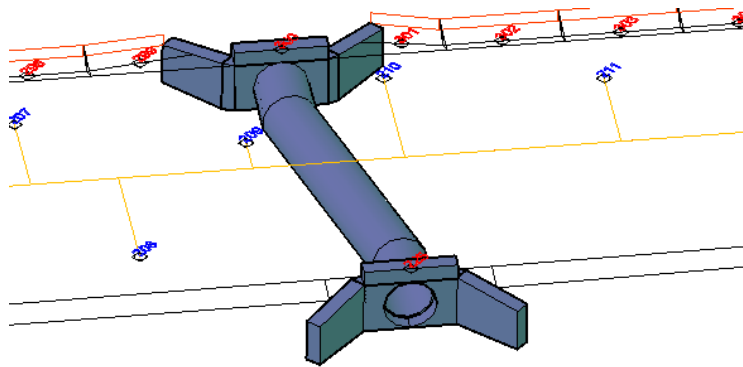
Estructura de drenaje transversal, modelo de la vía.
